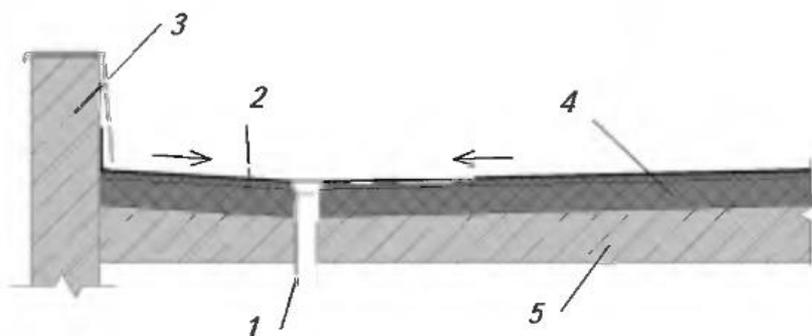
Схема покрытия с рулонной кровлей: 1 – водосток, 2 – гидроизоляция, 3 – парапет, 4 – теплоизоляция, 5 – плита основания.
